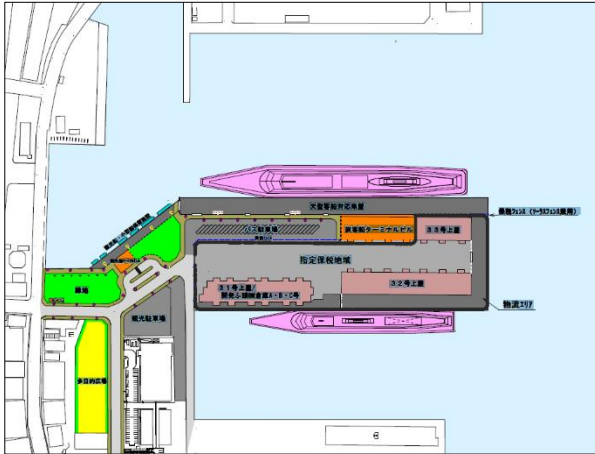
現在の第3ふ頭配置図 (小樽市提供)
